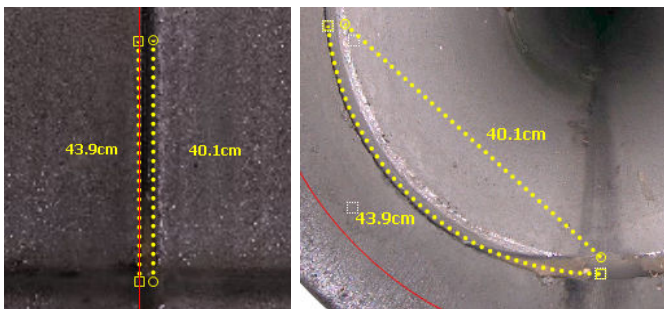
Links: Ansicht im Sidescan einer 2D- und einer 3D-Messung. Rechts: Dieselben Messungen in der Frontansicht.
